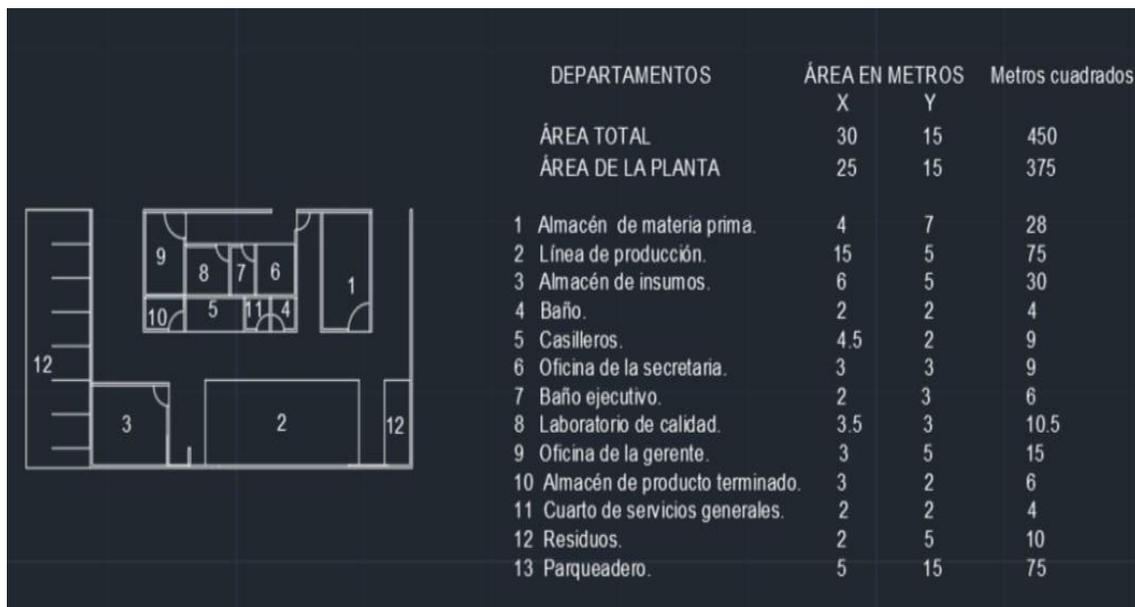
Distribución planta y sus departamentos elaborados en AutoCAD [Elaboración propia]
